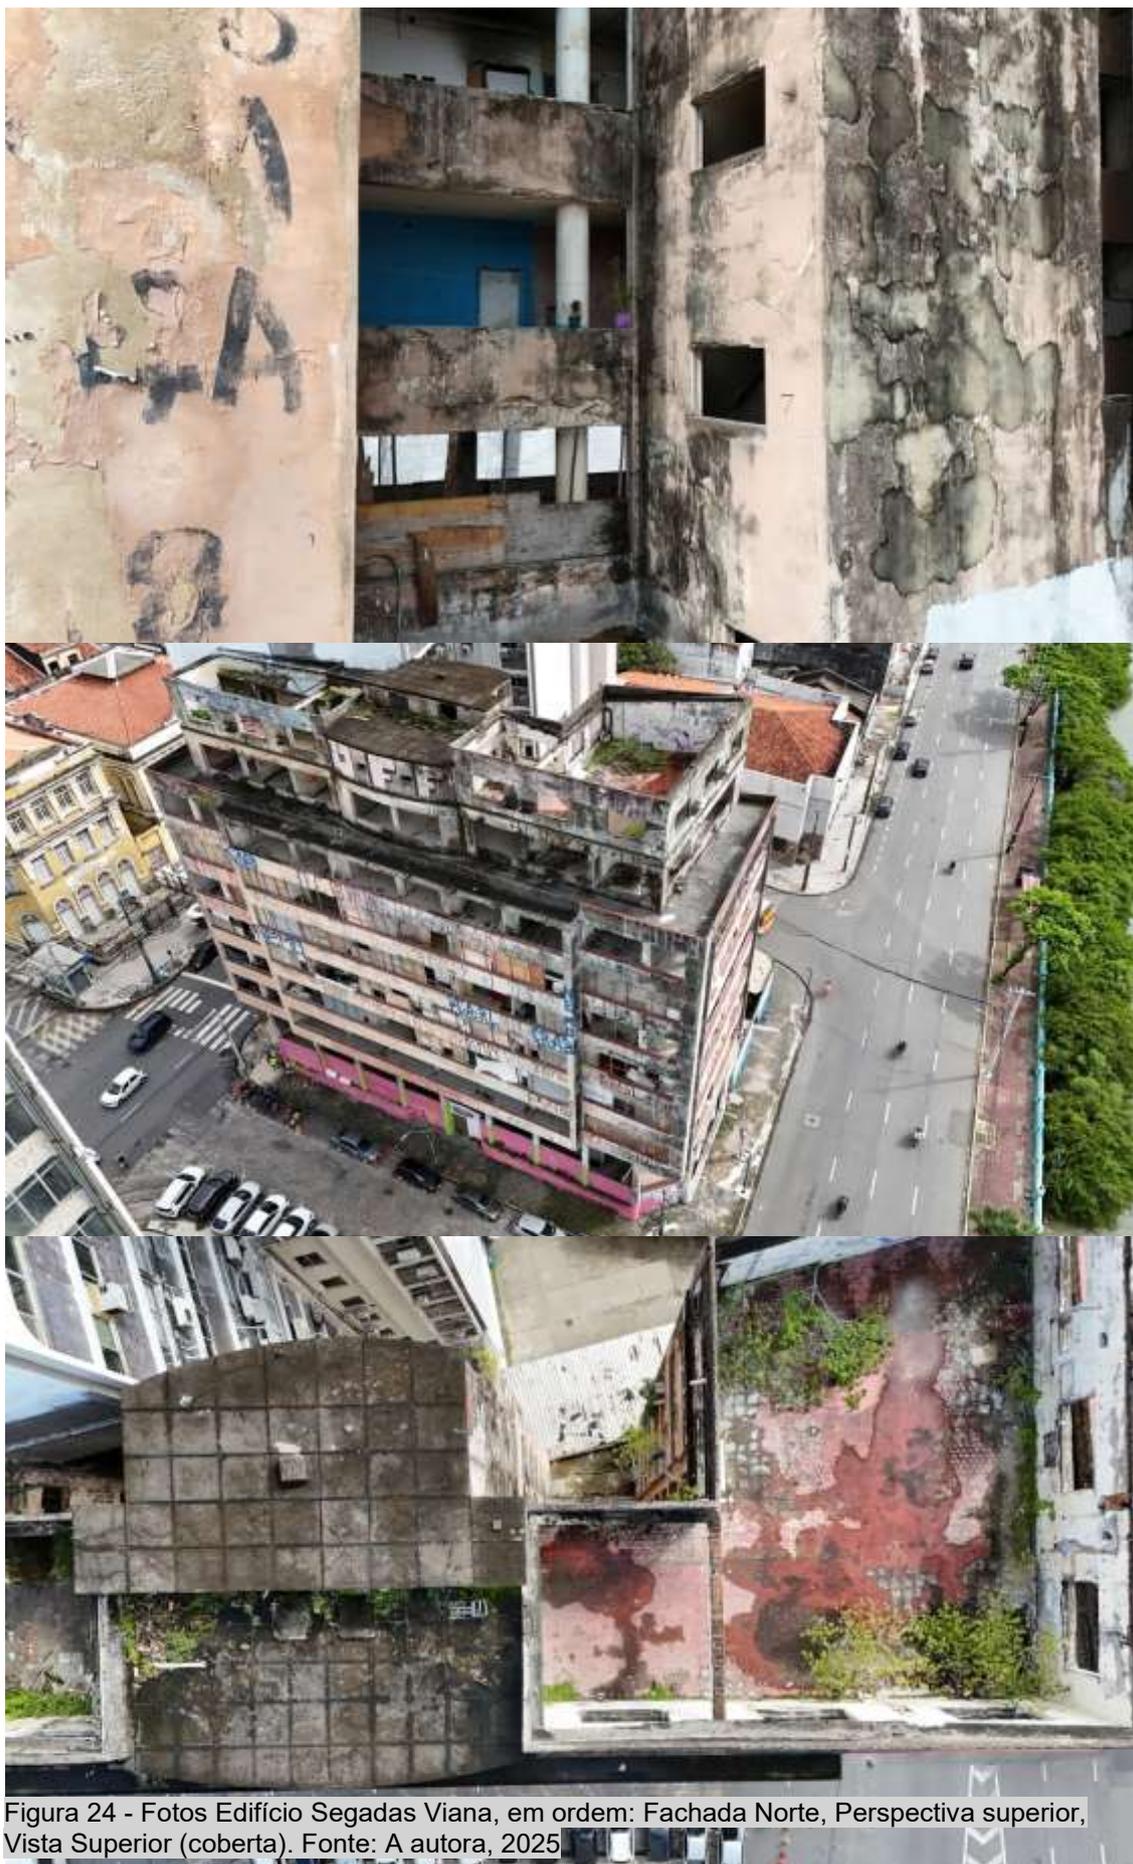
Fotos Edifício Segadas Viana, em ordem: Fachada Norte, Perspectiva superior, Vista Superior (coberta). Fonte: A autora, 2025
